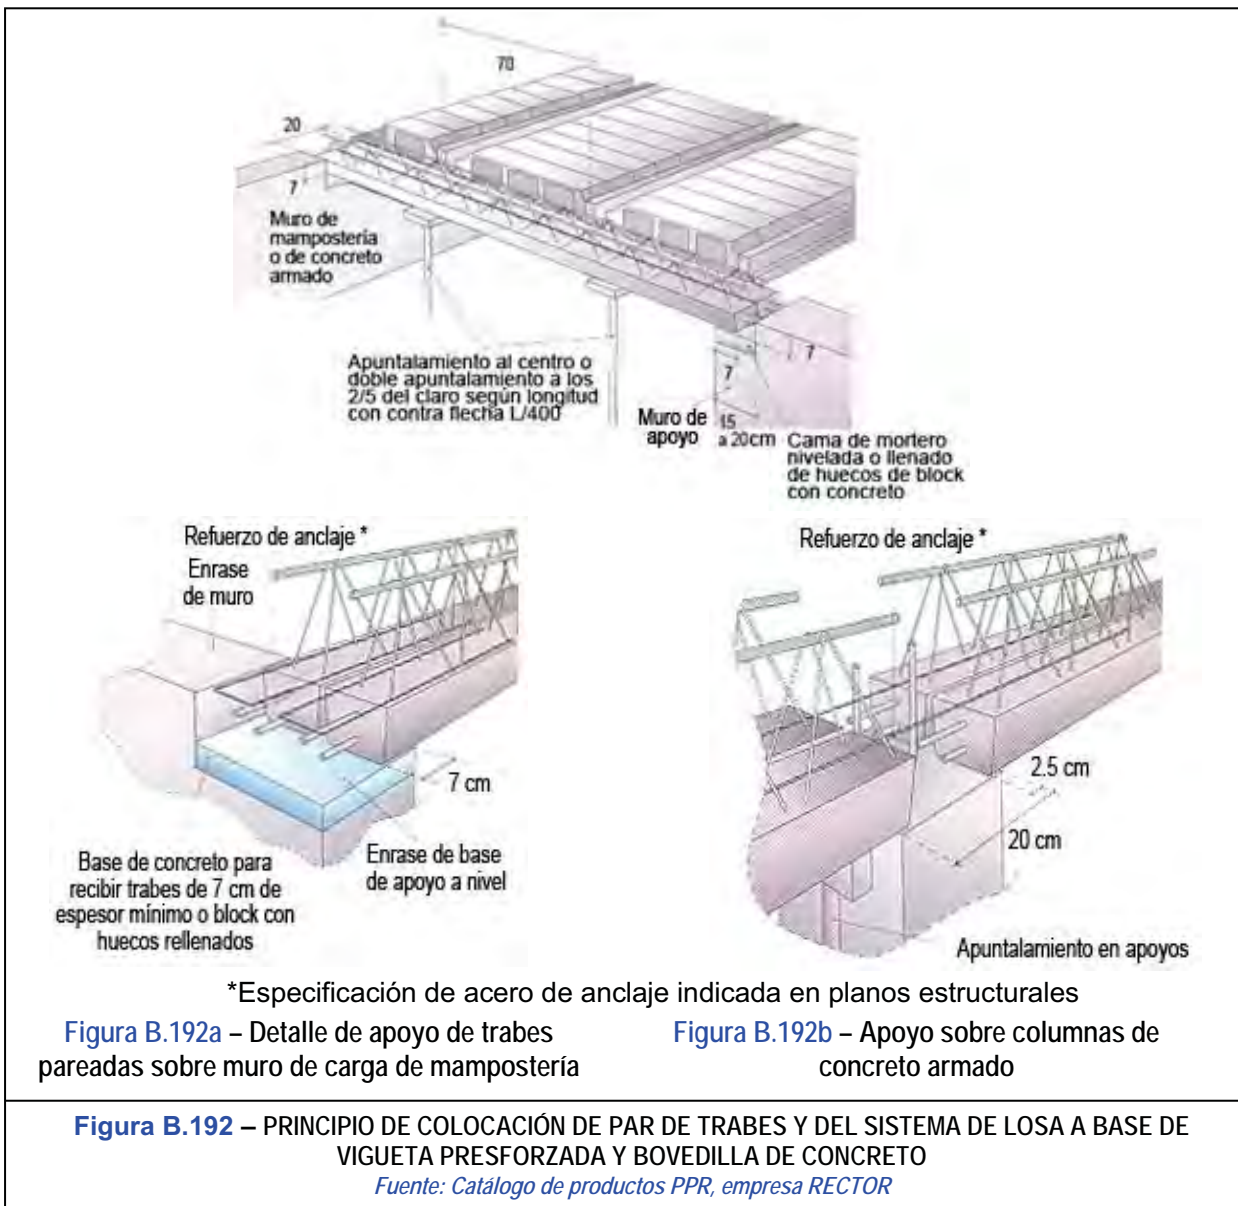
Detalle de apoyo de traves pareadas sobre muro de carga de mampostería
